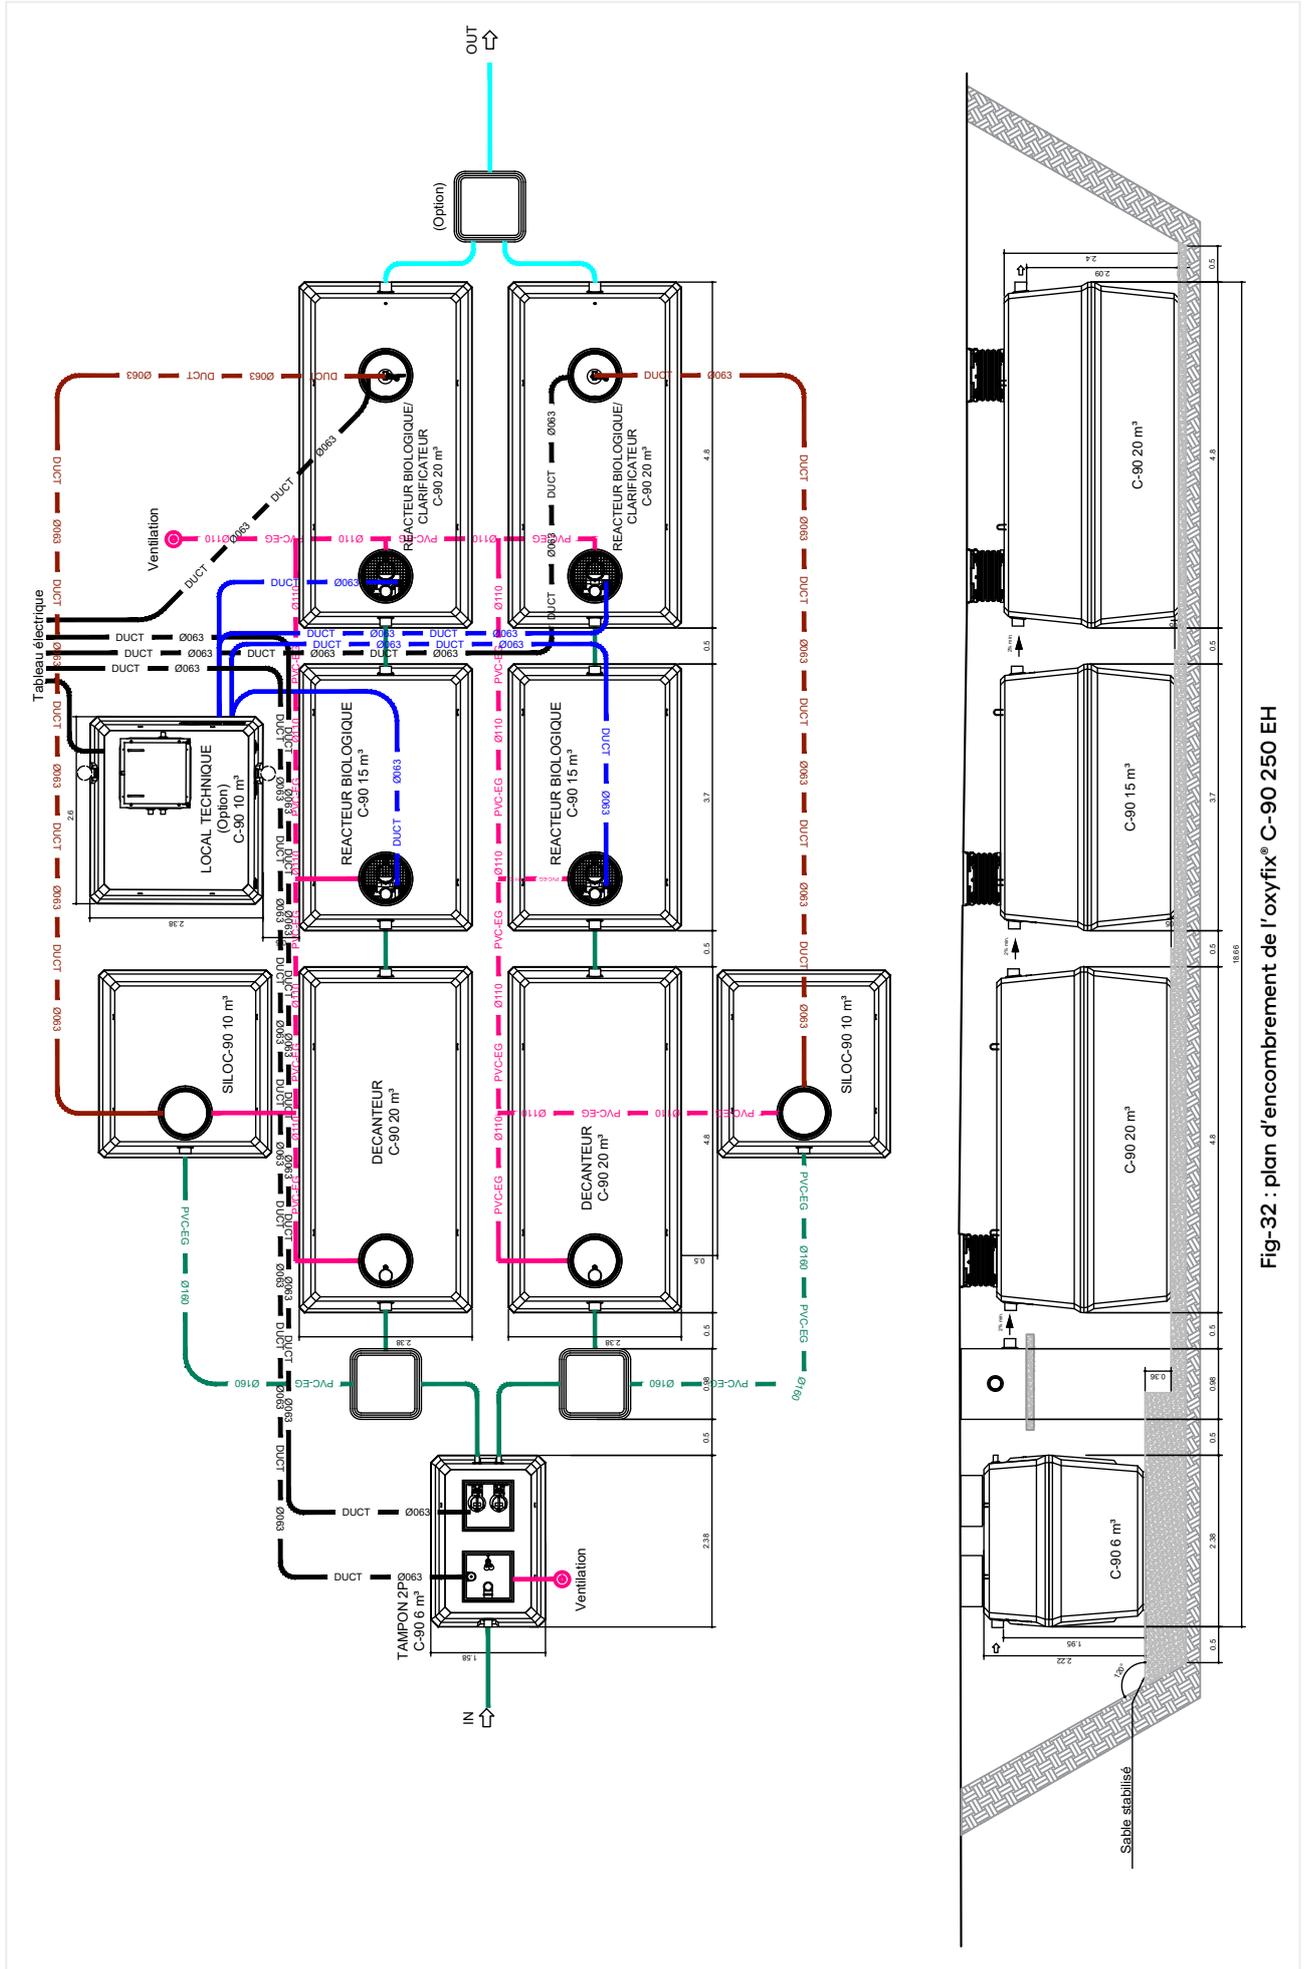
plan d'encombrement de l'oxyfix® C-90 250 EH
